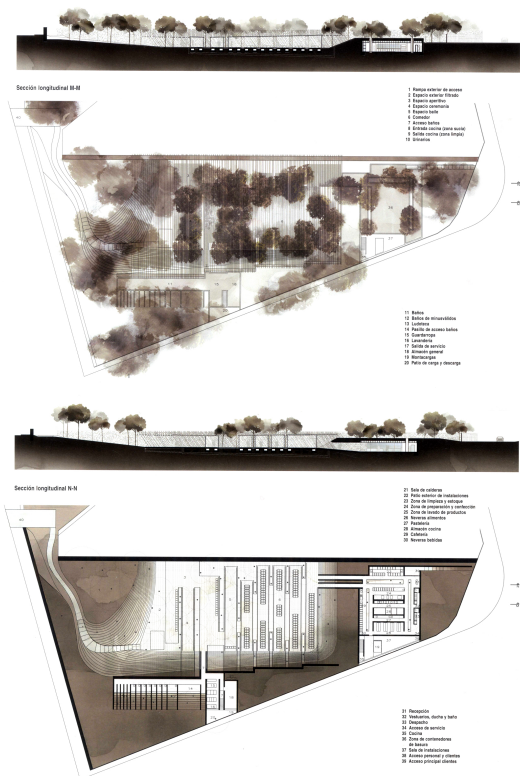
Planta general y planta cubierta de la carpa y secciones principales.
